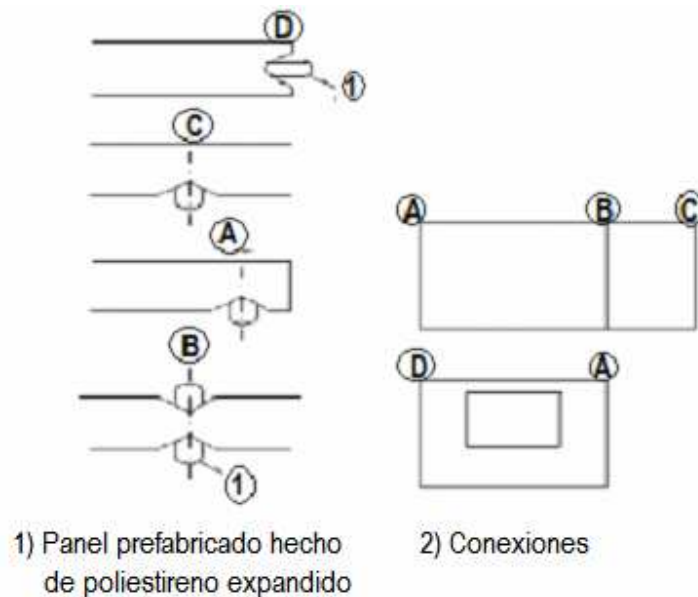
Sistema de paneles portantes. Esquemas. A-Detalle de conexión lateral de borde, B-Detalle de conexión por dos caras, C-Detalle de conexión lateral, D-Detalle de conexión frontal, 1-Panel prefabricado, 2-Armadura de conexión.
